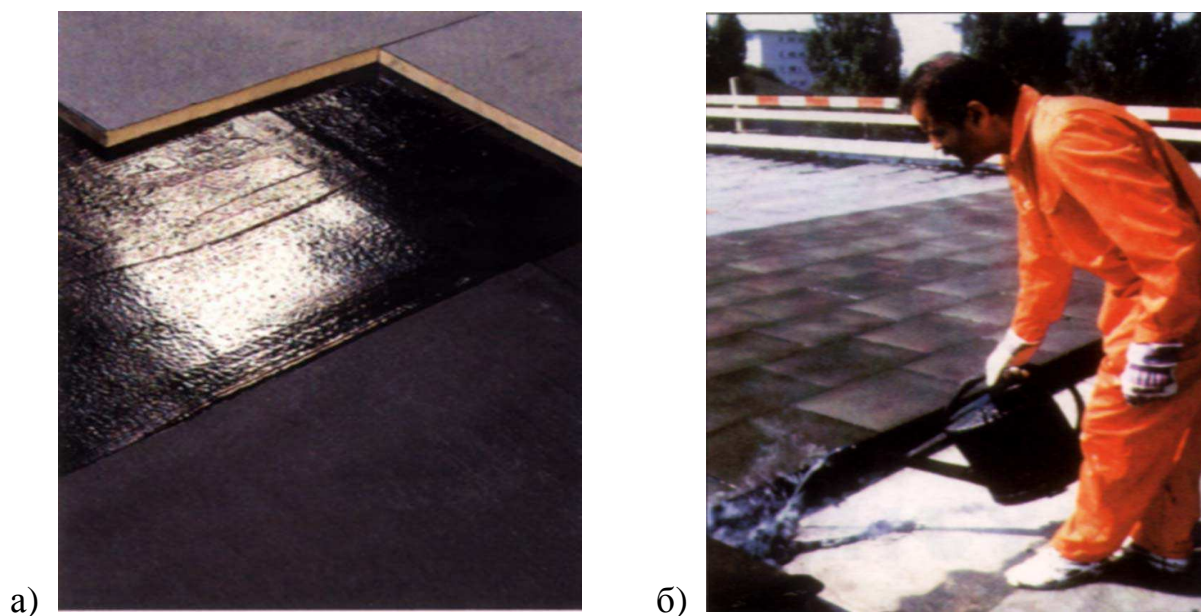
Укладка жёстких плит на основание из железобетонных плит из приклеиванием мастикой:
